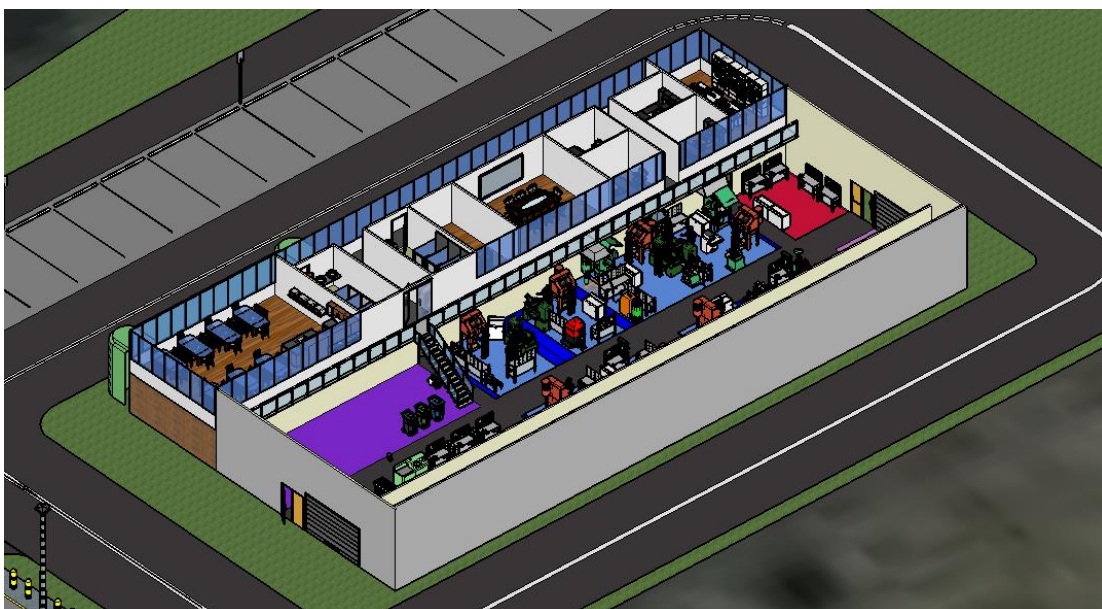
Distribución de Planta en Detalle - 1er y 2do Piso - Vista Isométrica
